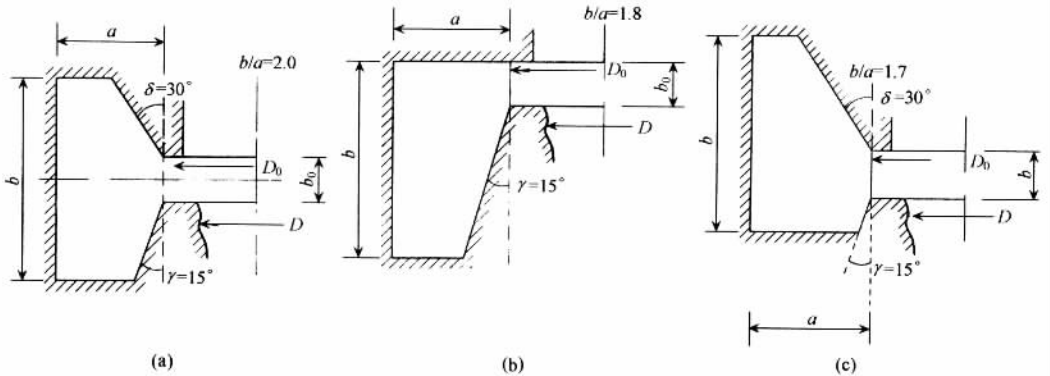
梯形断面的钢筋混凝土蜗壳型压水室
